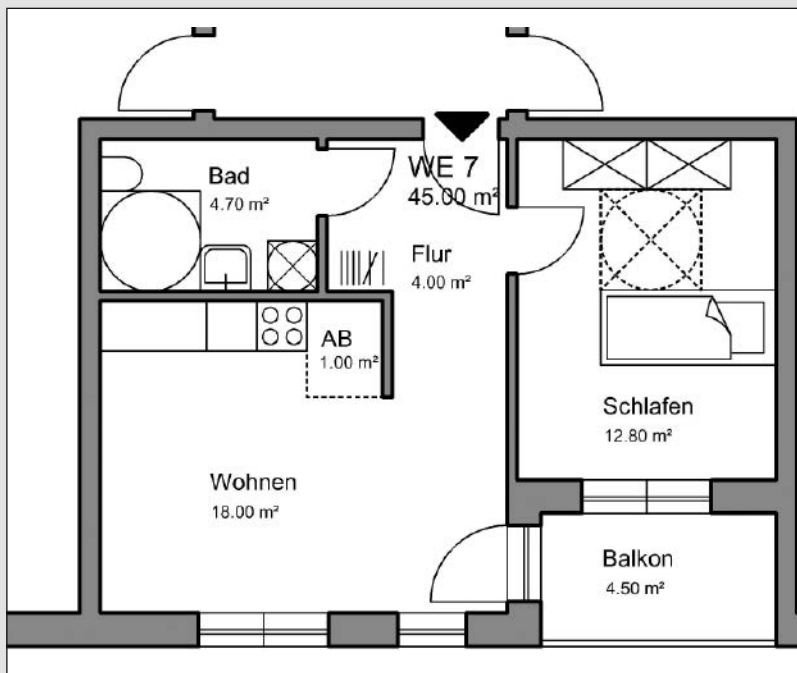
Beispiel Grundriss Einpersonenhaushalt
